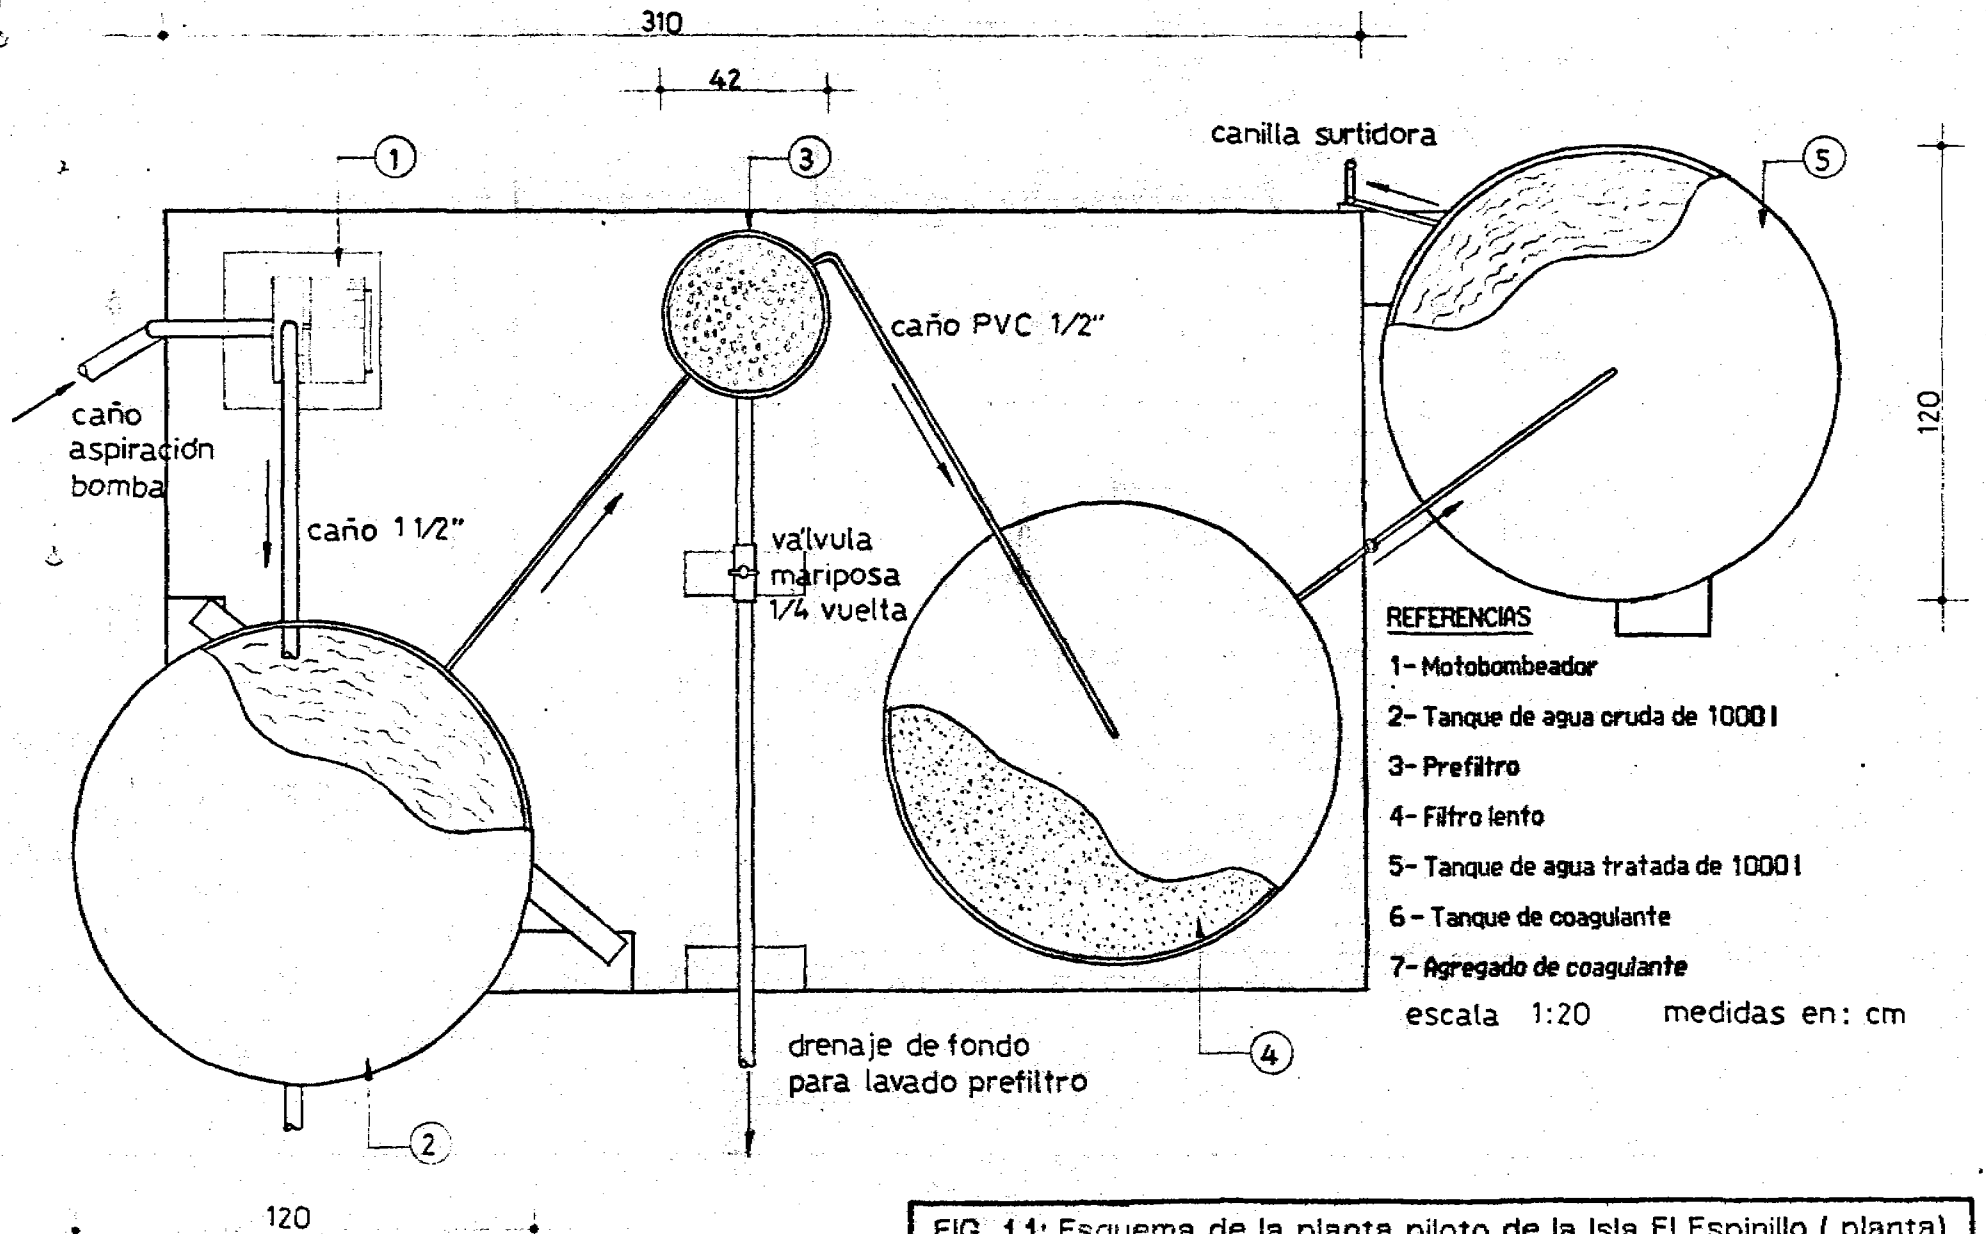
Esquema de la planta piloto de la Isla El Espinillo (planta)
